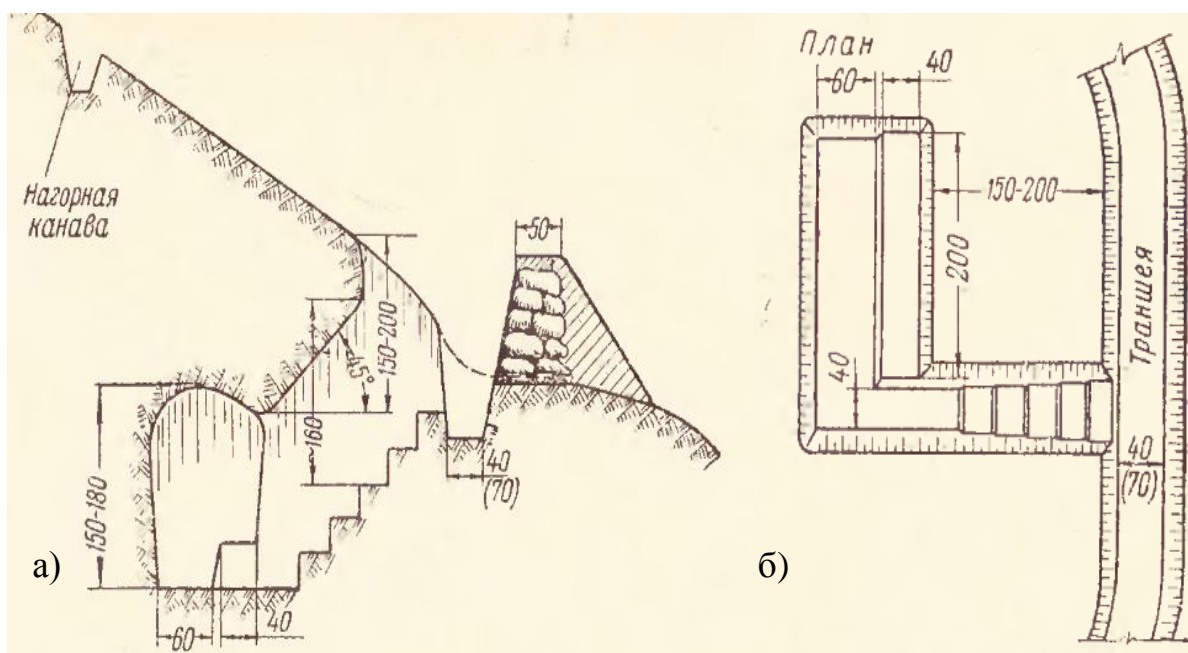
Укрытие подземного типа в скальном грунте: а) разрез; б) план
